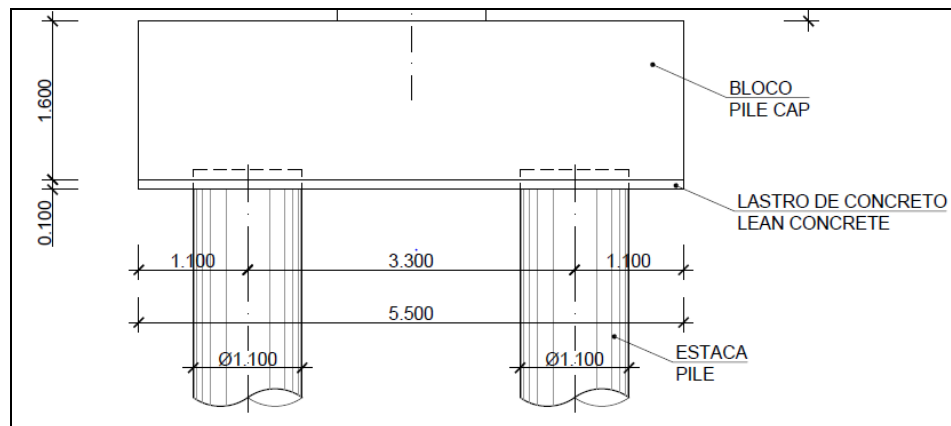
Detalhe do Bloco de Fundação.
